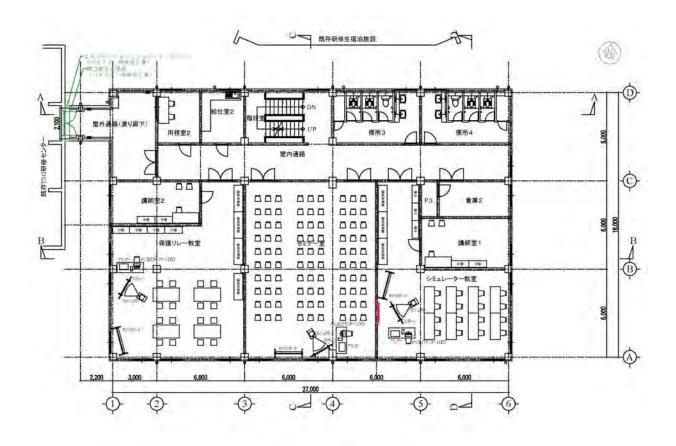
送変電訓練用シミュレーター研修施設 2 階(First Floor)配置図
